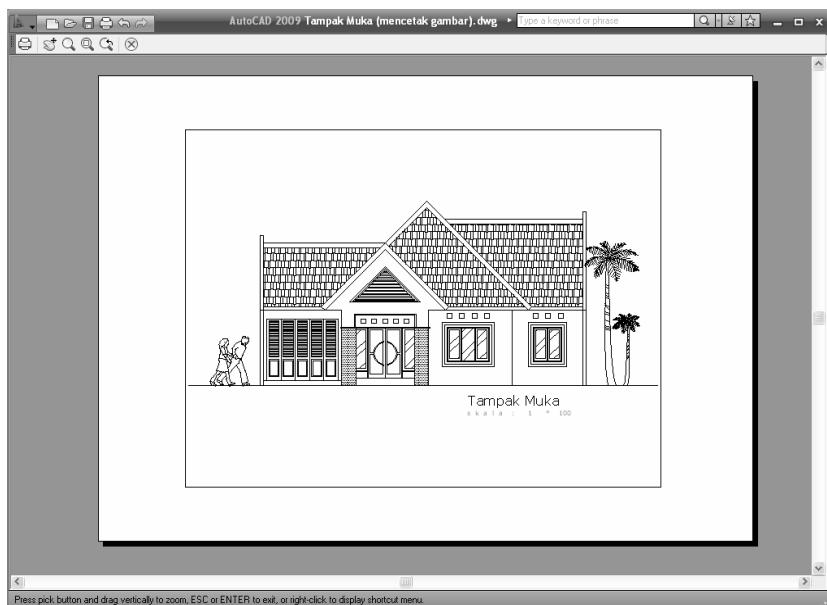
Tampilan gambar dan pilihan Layout2
